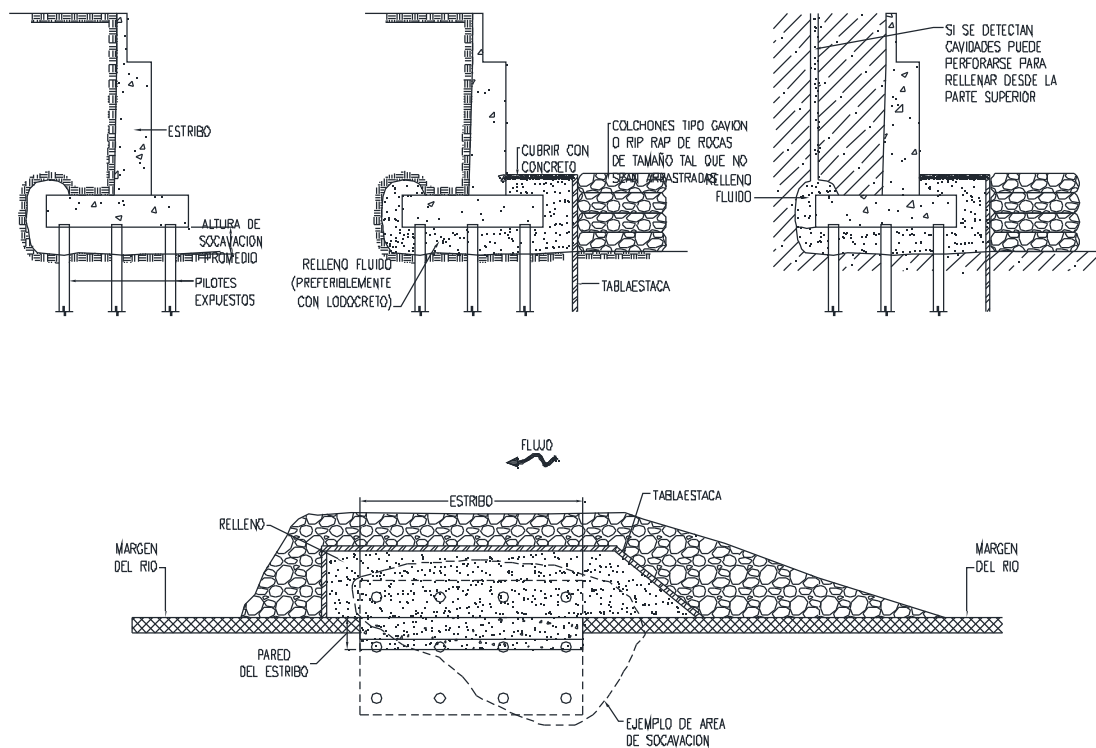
Propuesta de reparación en estribos con socavación severa. (SPOP, 2014)
